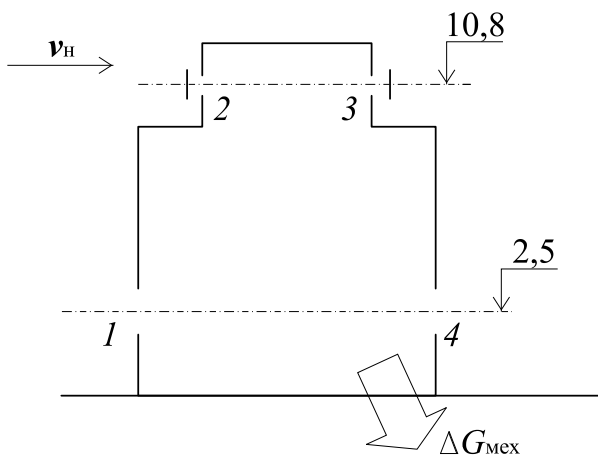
Вертикальный разрез здания и схема связей помещения с наружным воздухом:
